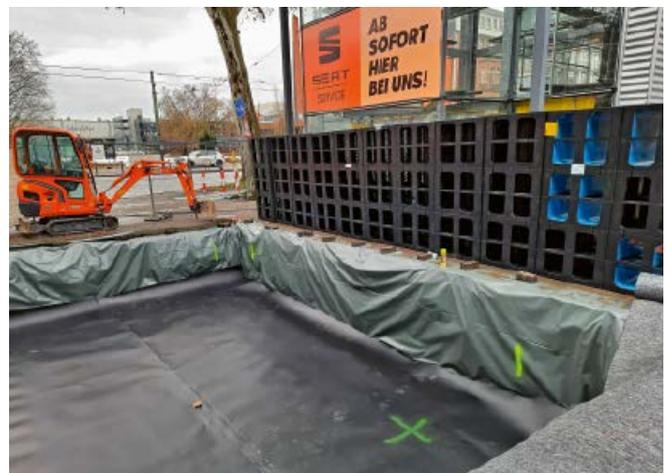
Bau einer unterirdischen Versickerungsanlage
